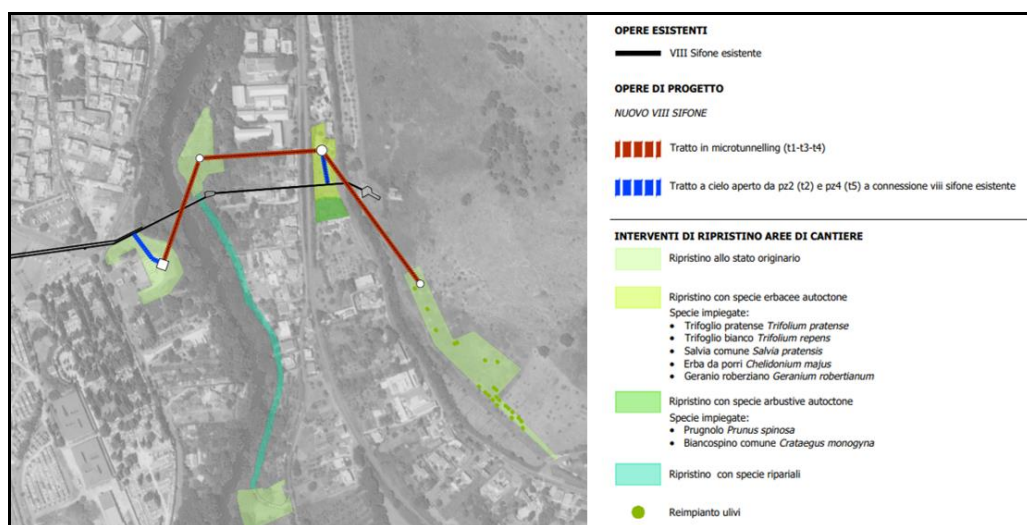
Stralcio della tavola "planimetria degli interventi di ripristino"
